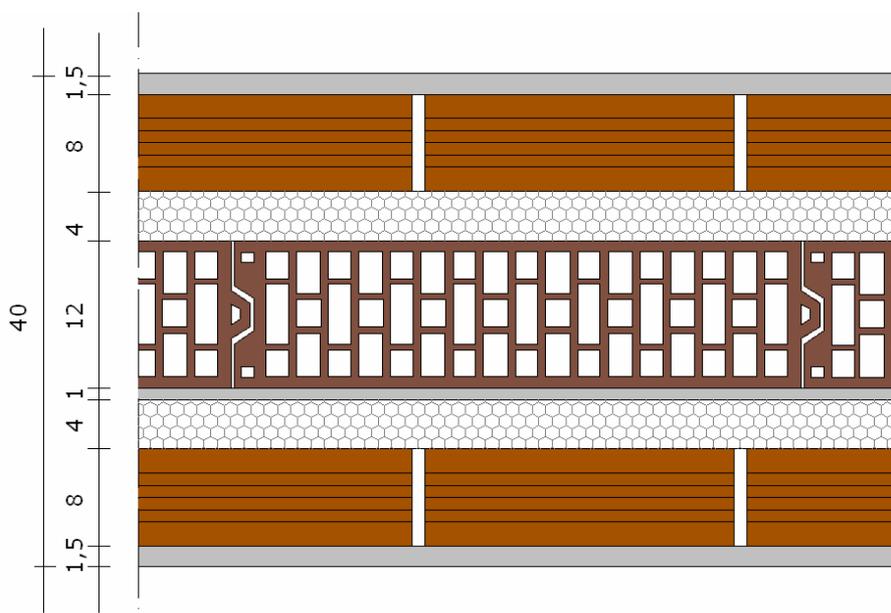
Sezione orizzontale della parete tra le cucine degli alloggi tipo A
